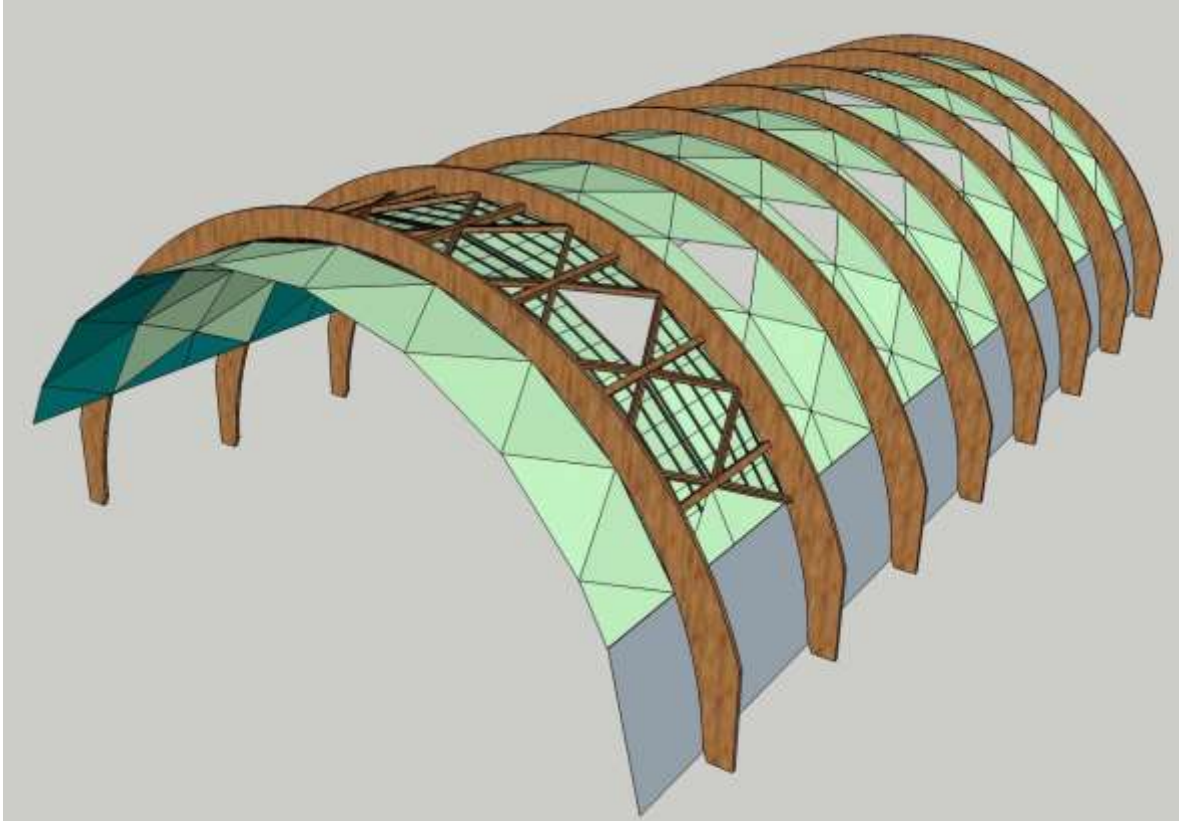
andamento controsoffitto secondo la curvatura delle centine strutturali
